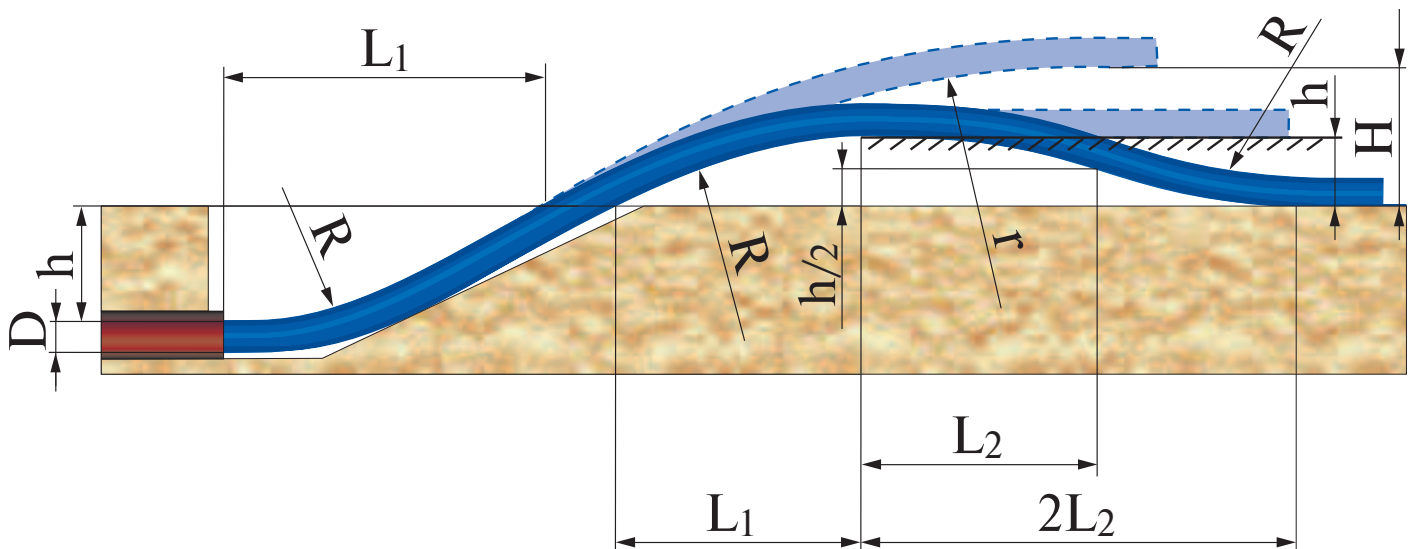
Укладка трубы ПРОТЕКТ в существующий трубопровод с поднятием трубы над поверхностью земли для сокращения длины котлована
